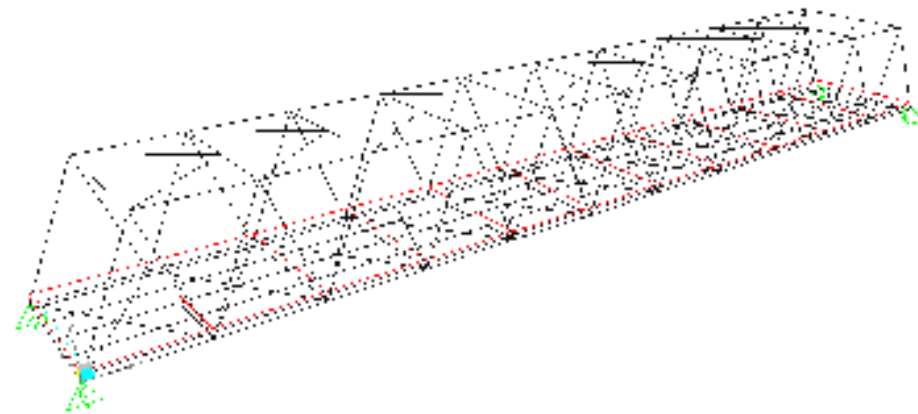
Denah rantai jembatan (sumbu x – y)
